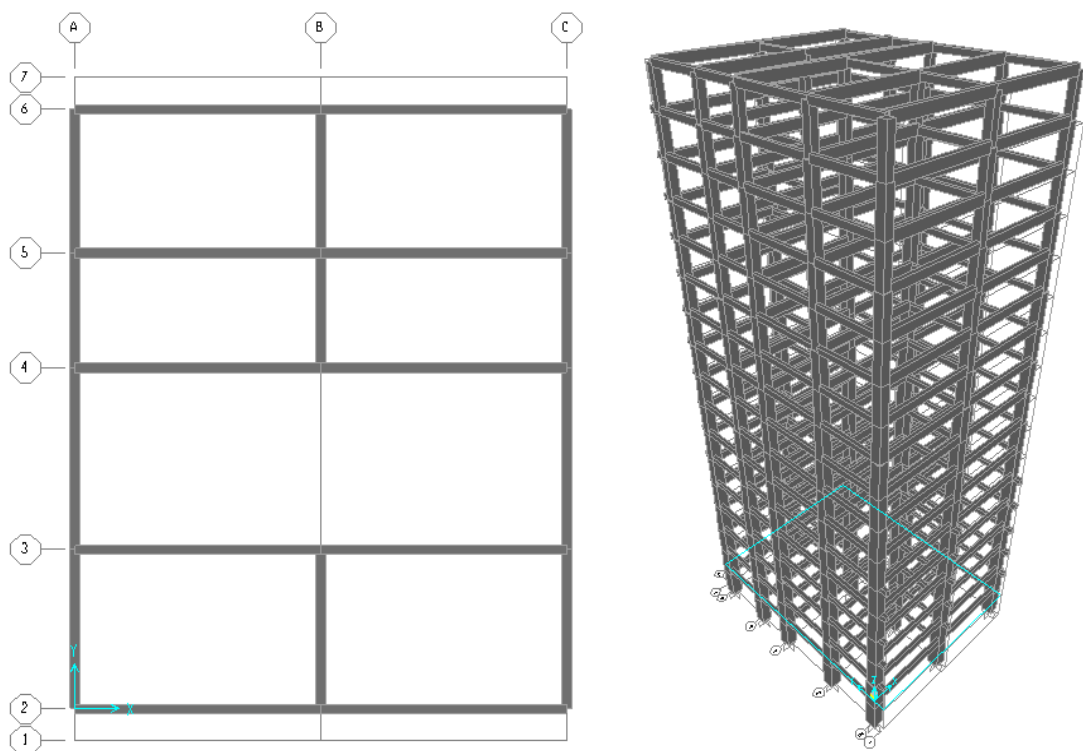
Géométrie en plan et en élévation de la structure
